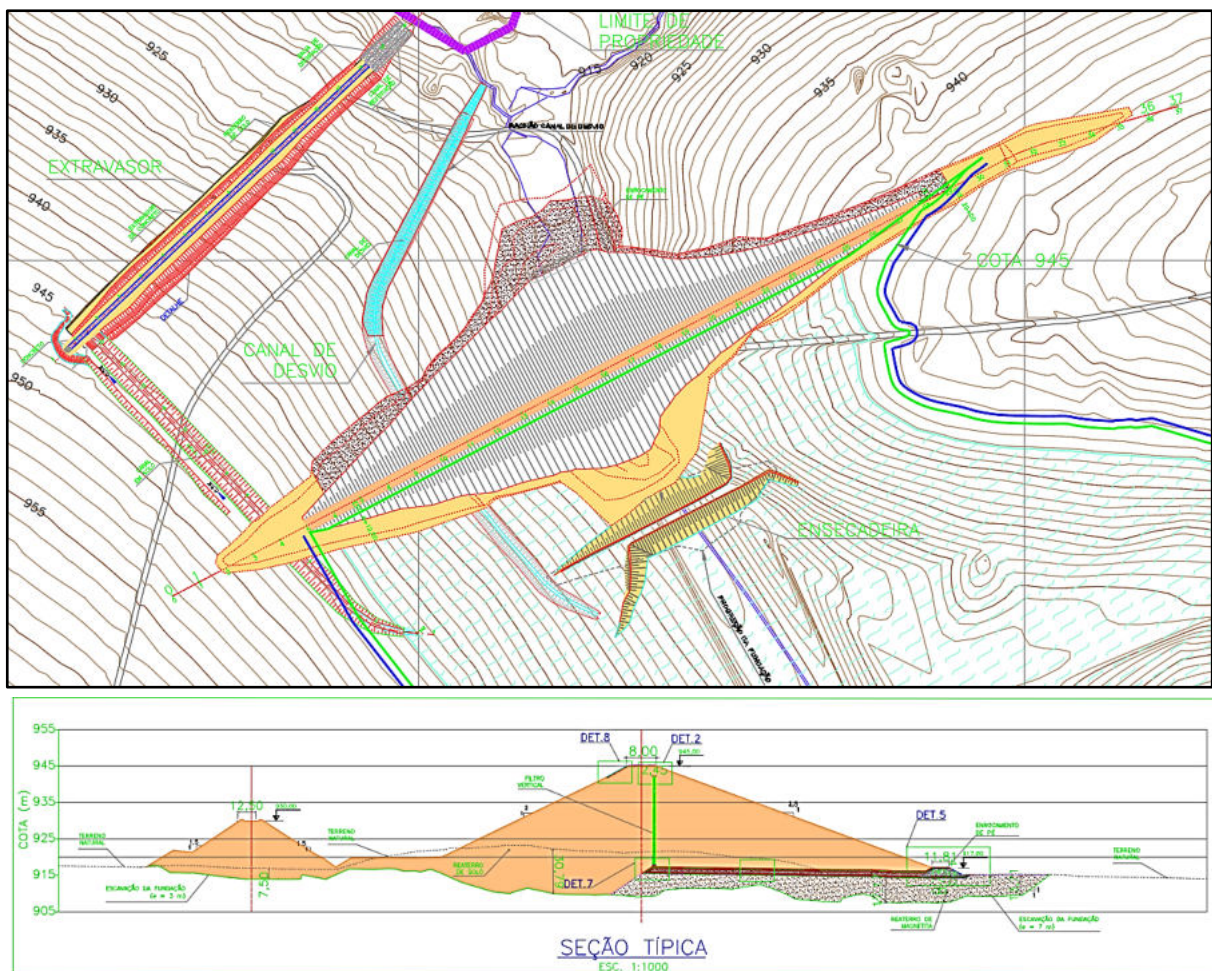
Arranjo geral e Seção típica da Barragem B6 (PIMENTA E PAVIDEZ, 2018)
